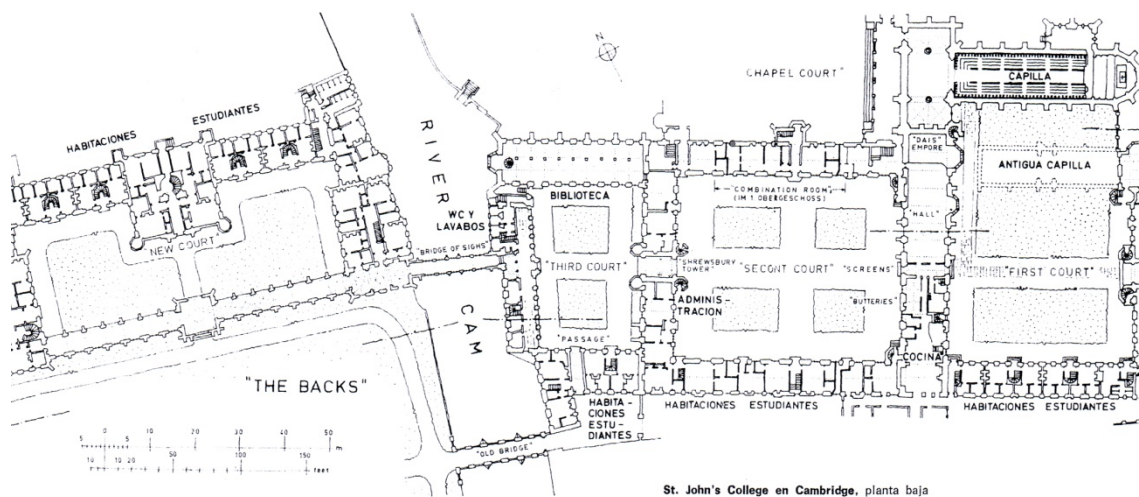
Planta piso térreo do Campus Universitário St. John's, Cambridge
